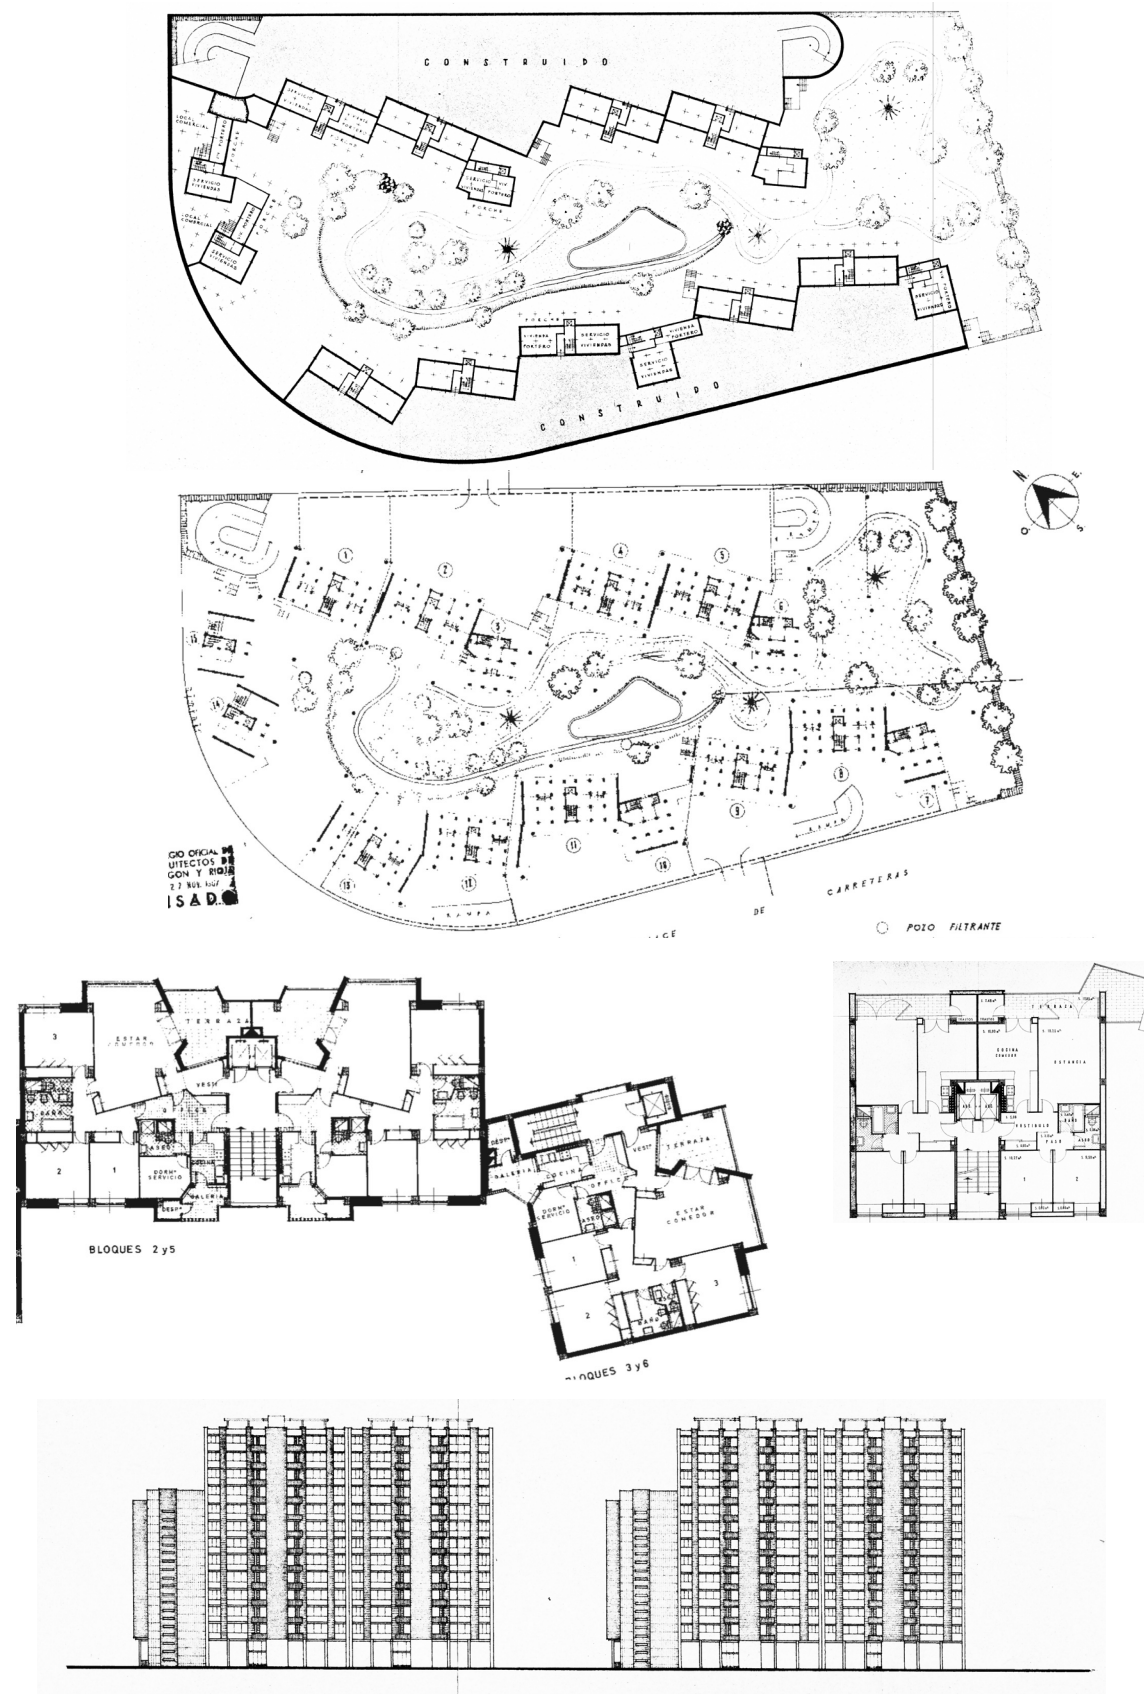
, 121, 122, 123 y 124. Planta Baja, Viviendas Tipo A-B, tipo C-D y tipo E y Alzado del Concurso para viviendas protegidas del Grupo Sal-duba. 1941
